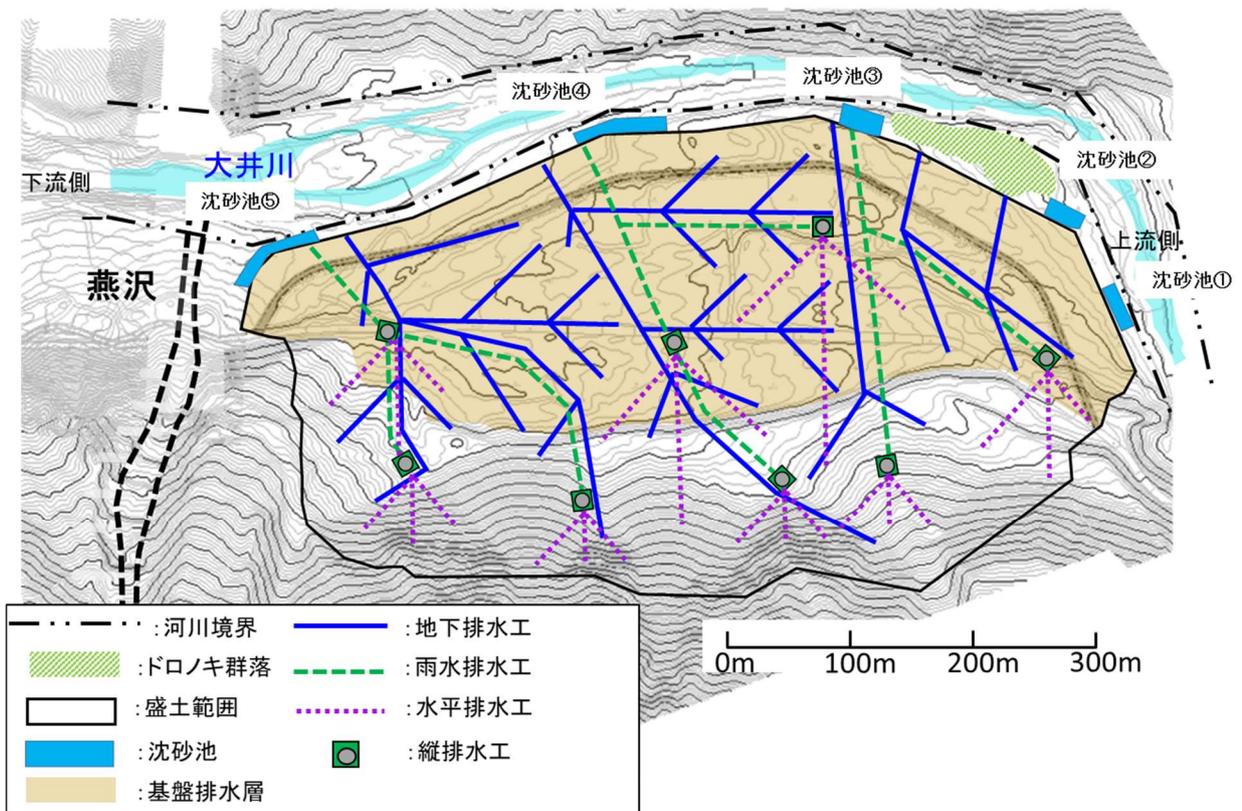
4 ツバク口発生土置き場（通常土）の排水設備計画平面図
